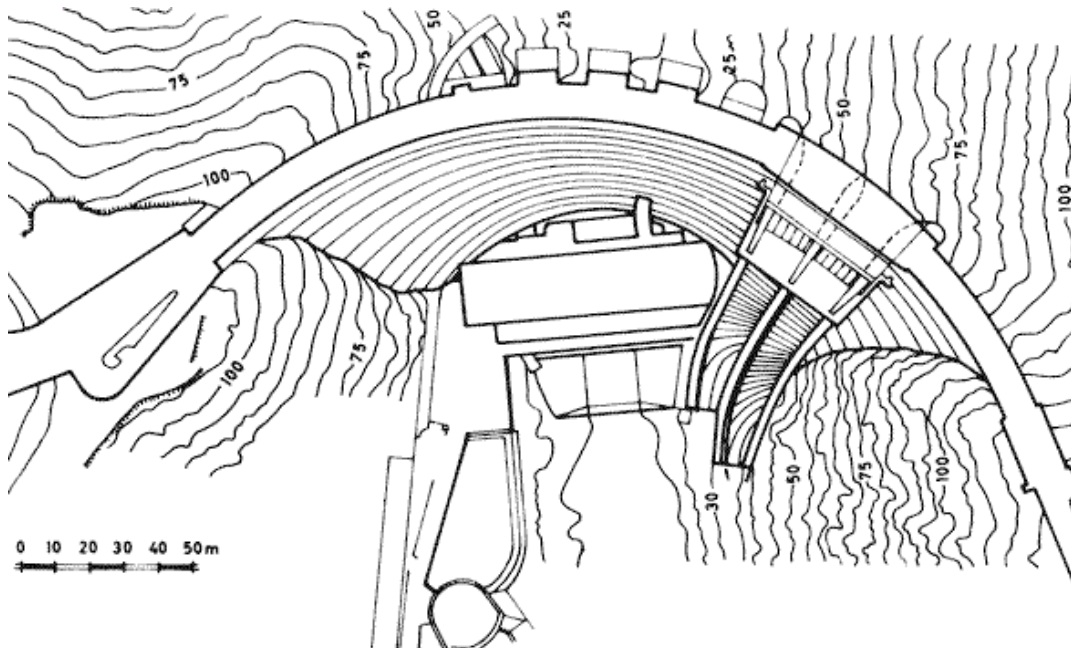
Planta da barragem de Castelo de Bode (Portugal, 1951) [93]
